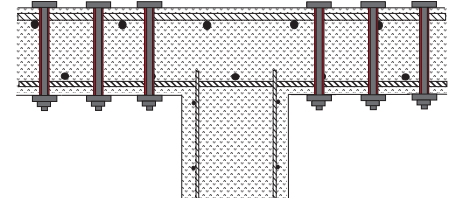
Durchgehende nachträgliche Durchstanzbewehrung
